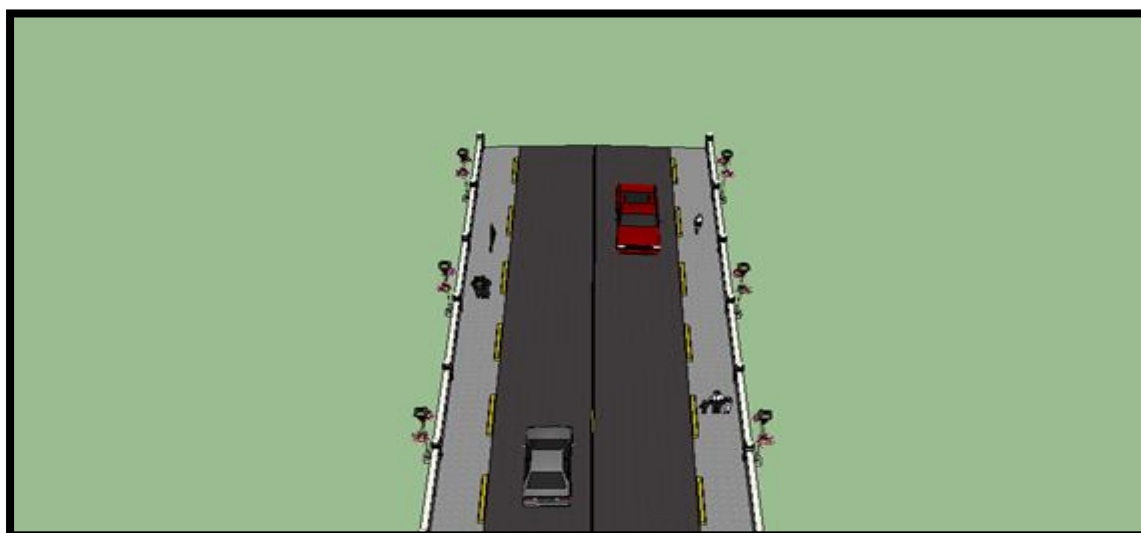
Superestructura de puente Guadalupe, vista en planta
